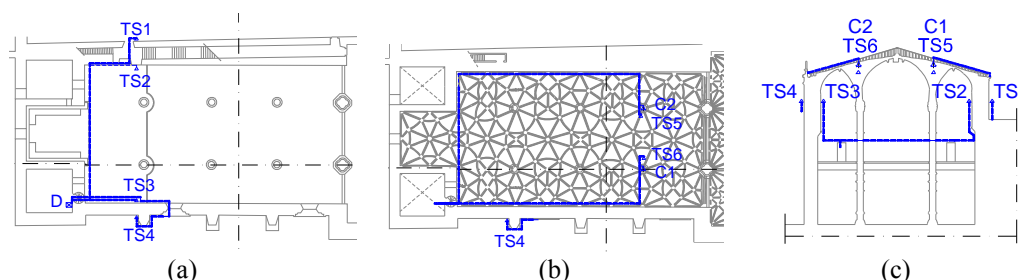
Sistema de monitorização estático: (a) planta da nave; (b) planta da abóbada da nave; (c) secção transversal da nave.
